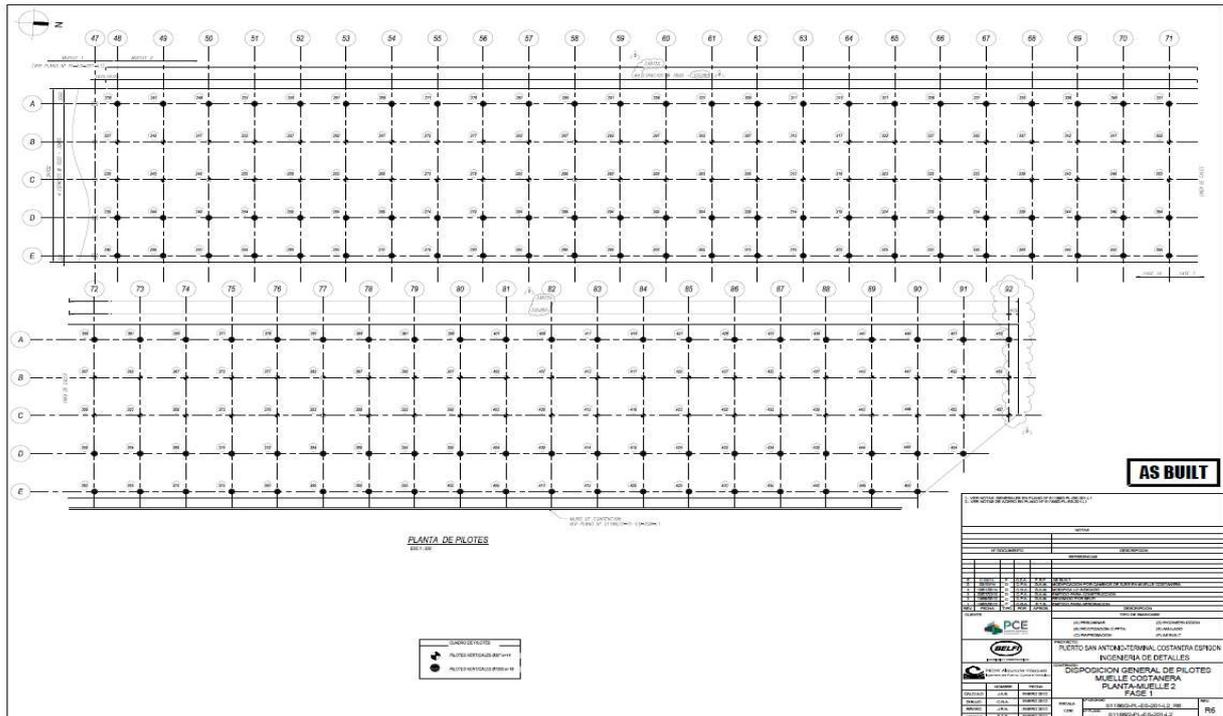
Disposición General Pilotes Muelle Cepas 47 a Cepa 92
